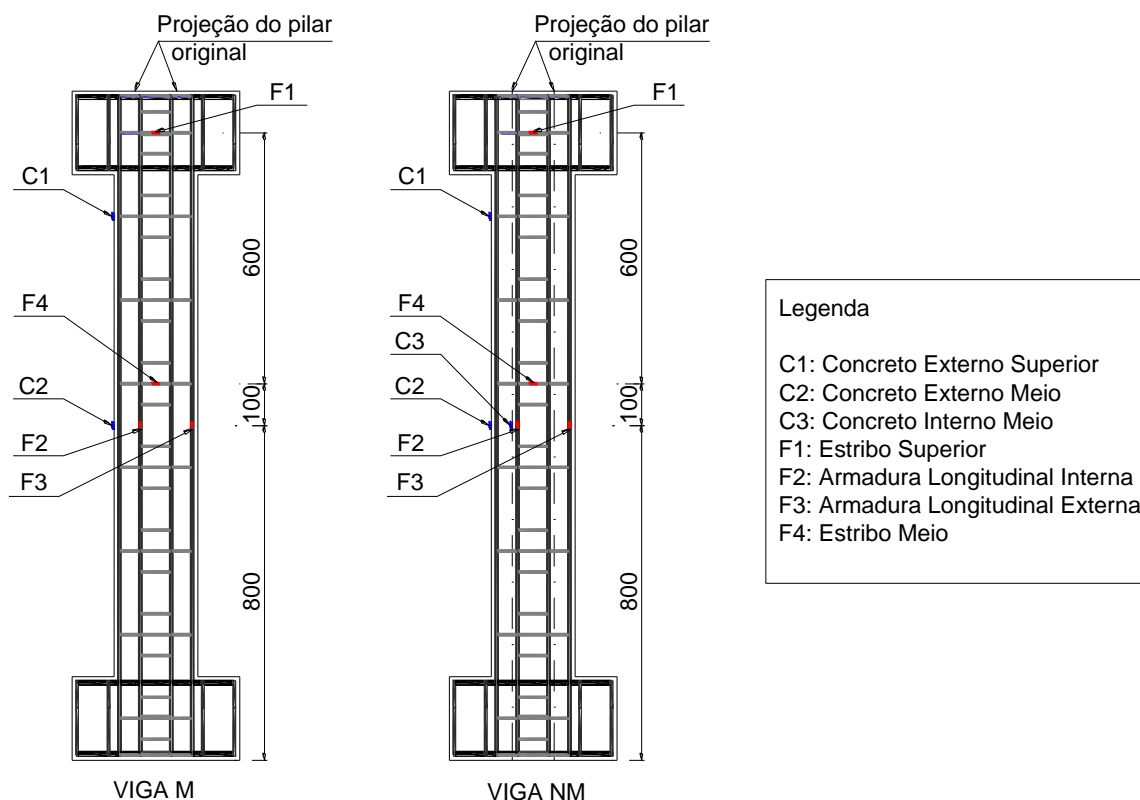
Posicionamento dos extensômetros nos pilares VIGA M e VIGA NM
